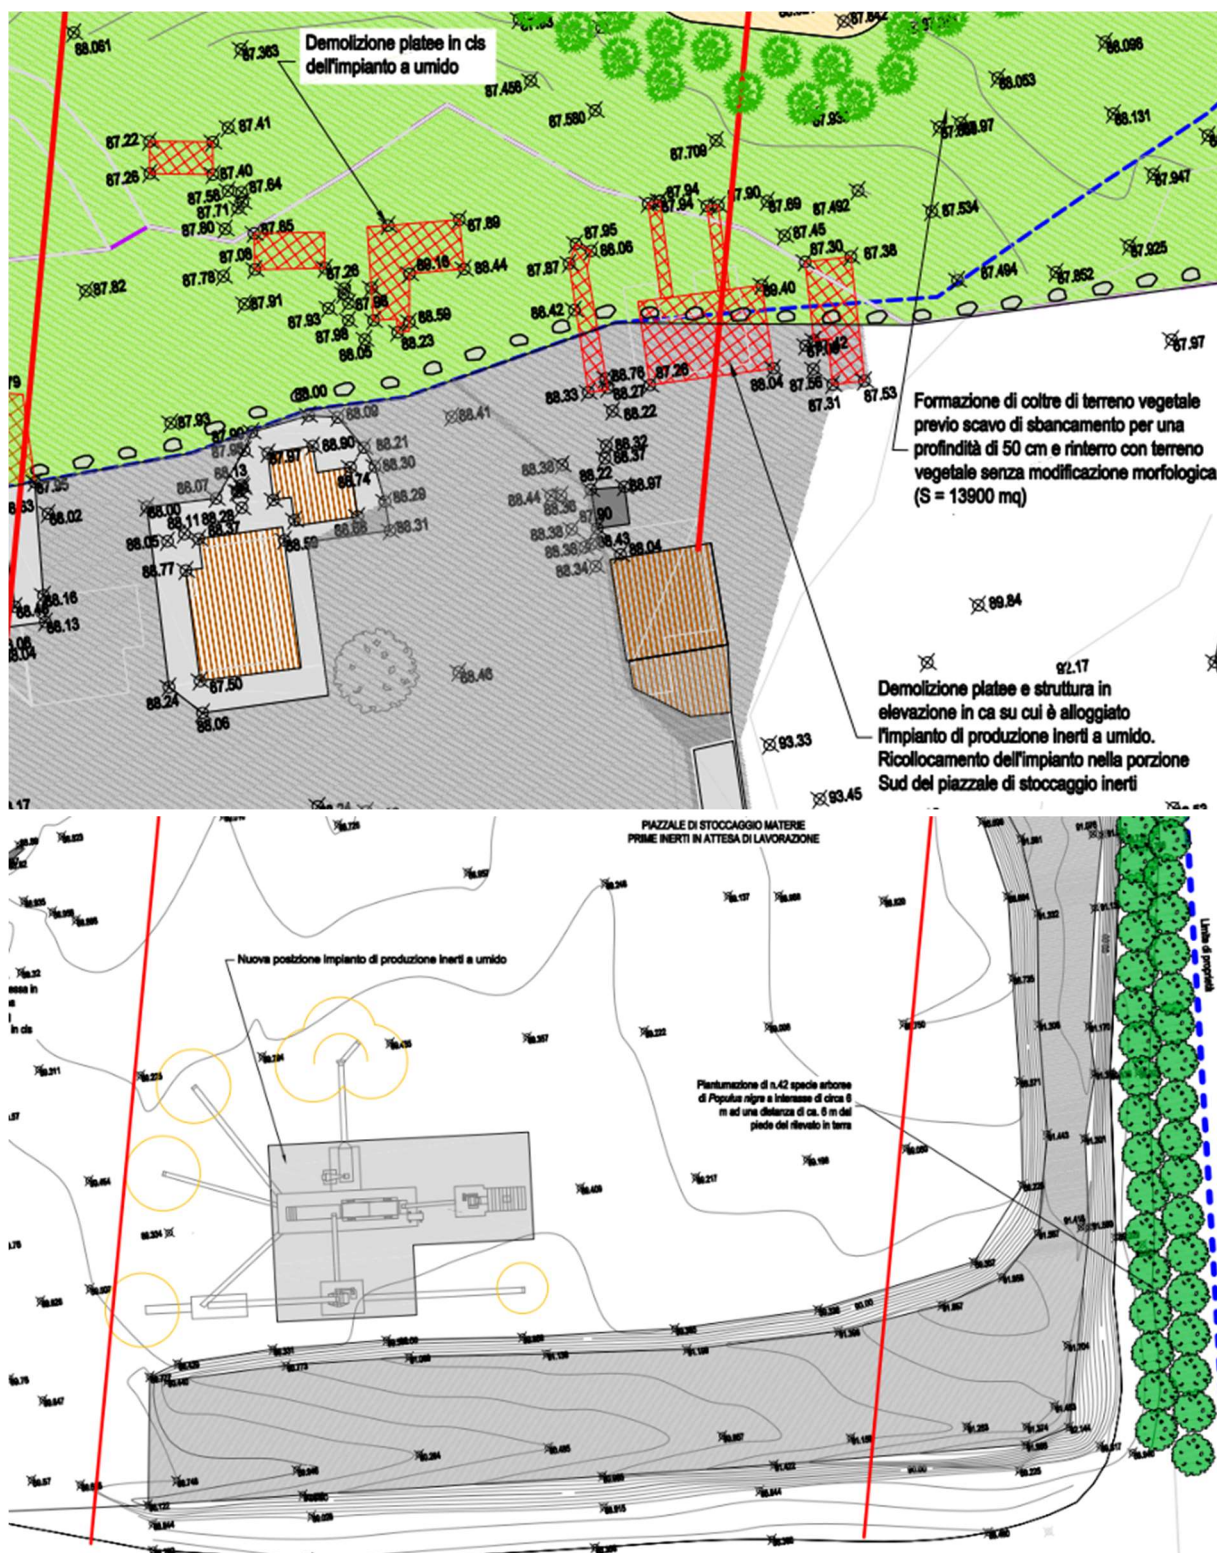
Estratto tavola 2A Planimetria di Progetto Stato Variante Stralcio 1 dove si evidenzia la rimozione allestimenti impianto trattamento inerti a umido (in alto) e nuova collocazione (in basso)
